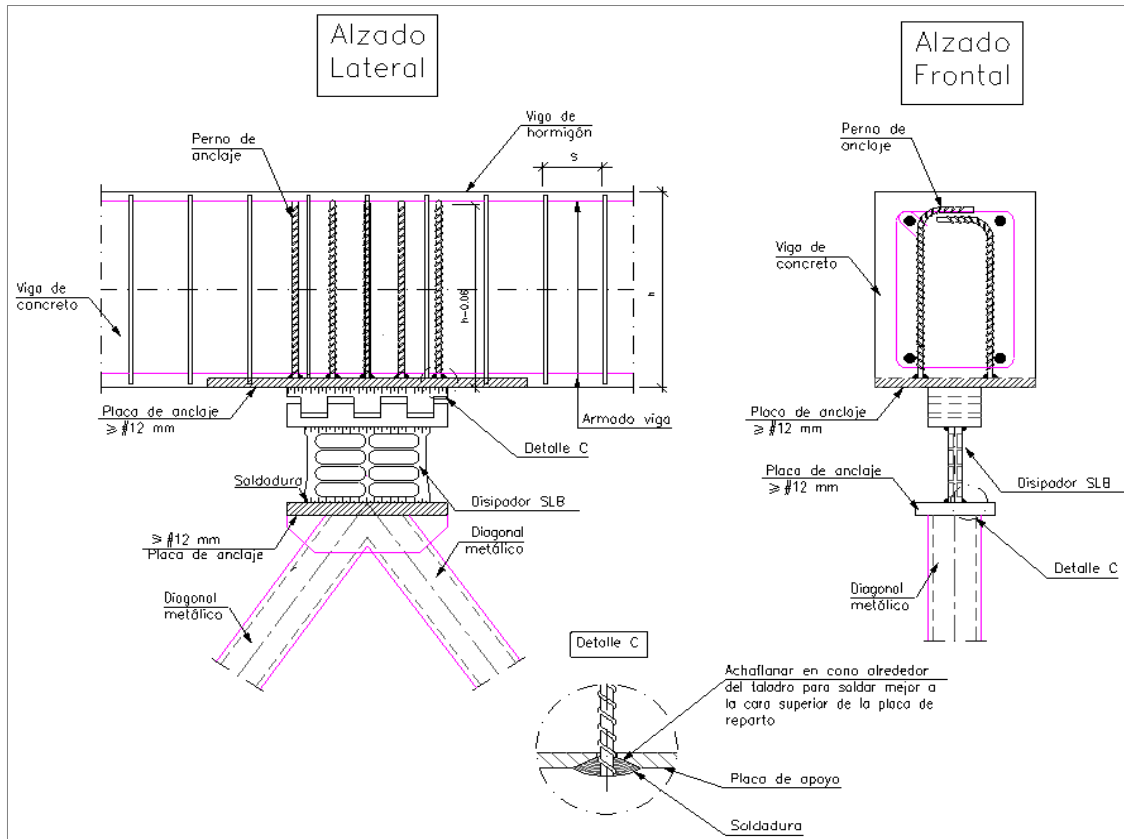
Detalle de anclaje, disipador SLB a viga de concreto
